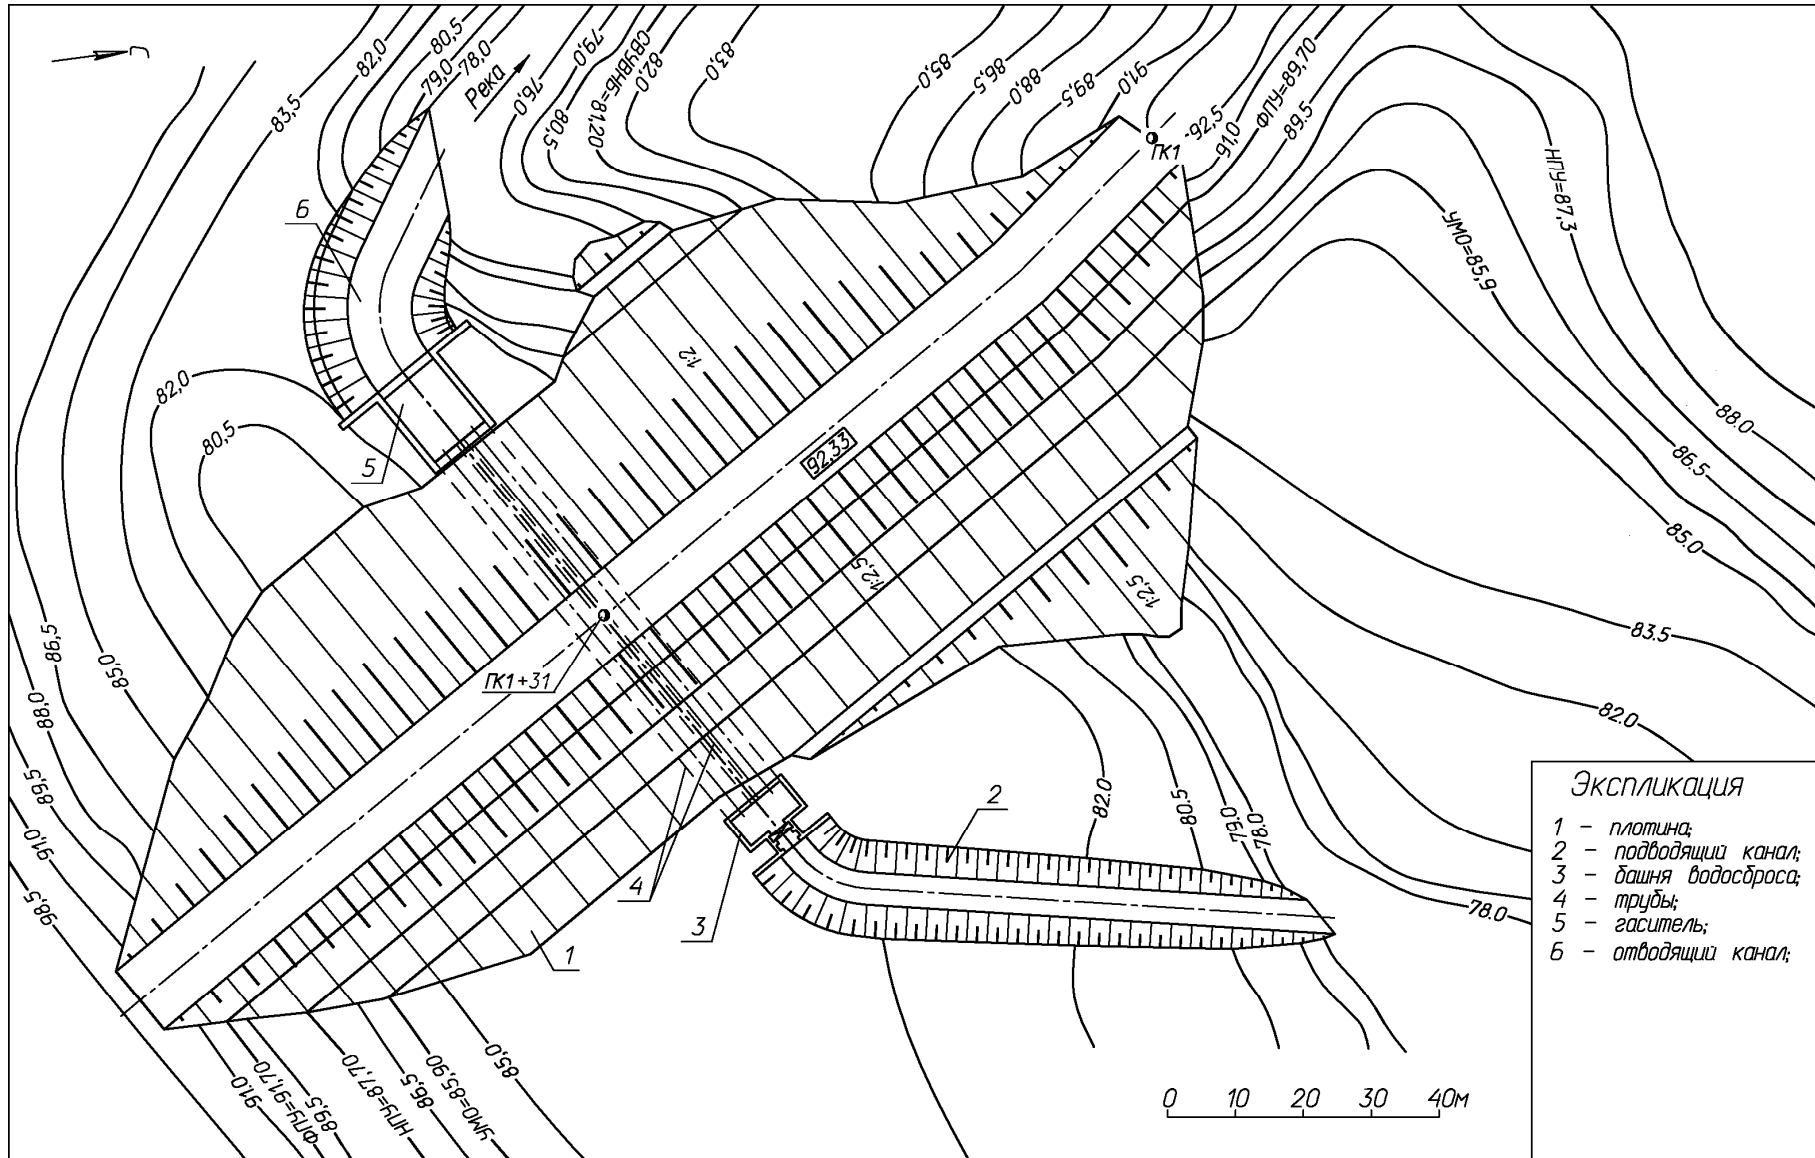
Генеральный план гидроузла с трубчатым водосбором
